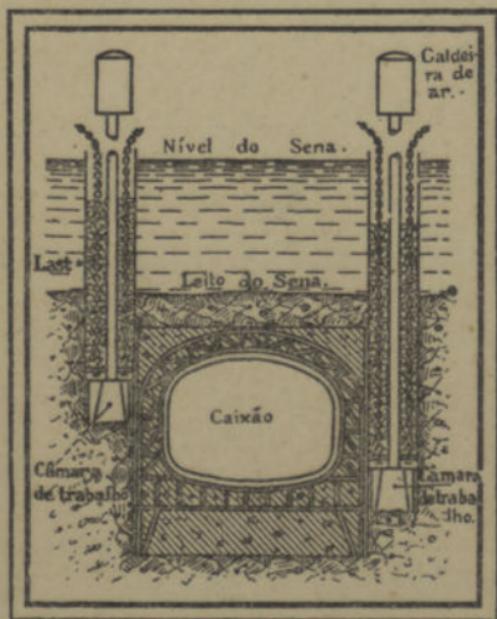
Processo adoptado para a ligação dos caixões no Sena. São descidos dois caixões no espaço destinado à construção dos pilares laterais.
